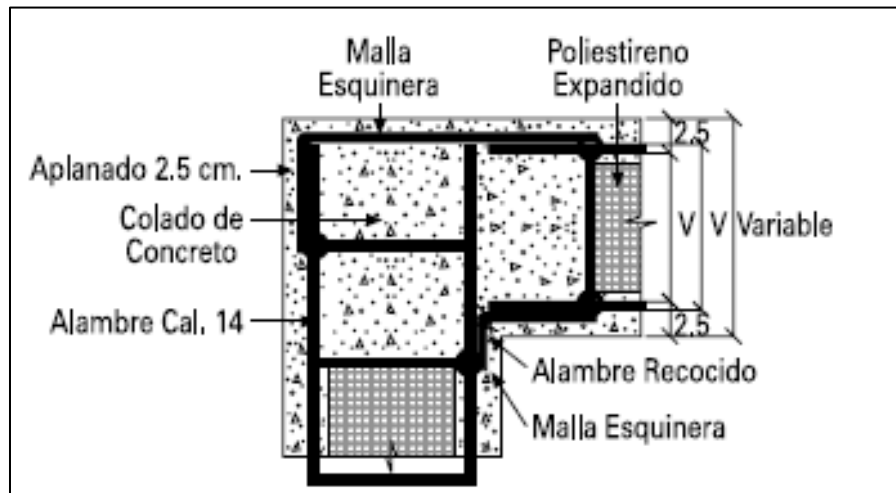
Detalle de ensamblaje esquineros de los paneles⁴⁴
